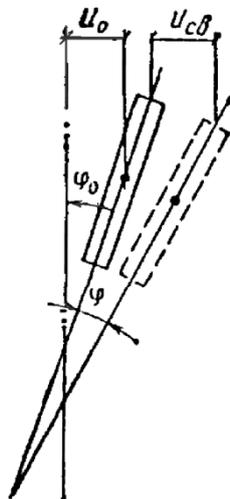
Перемещения поворота и погиби дощатоклееной балки покрытия из ее плоскости в середине пролета, выполняющей функции пояса поперечной связевой фермы
